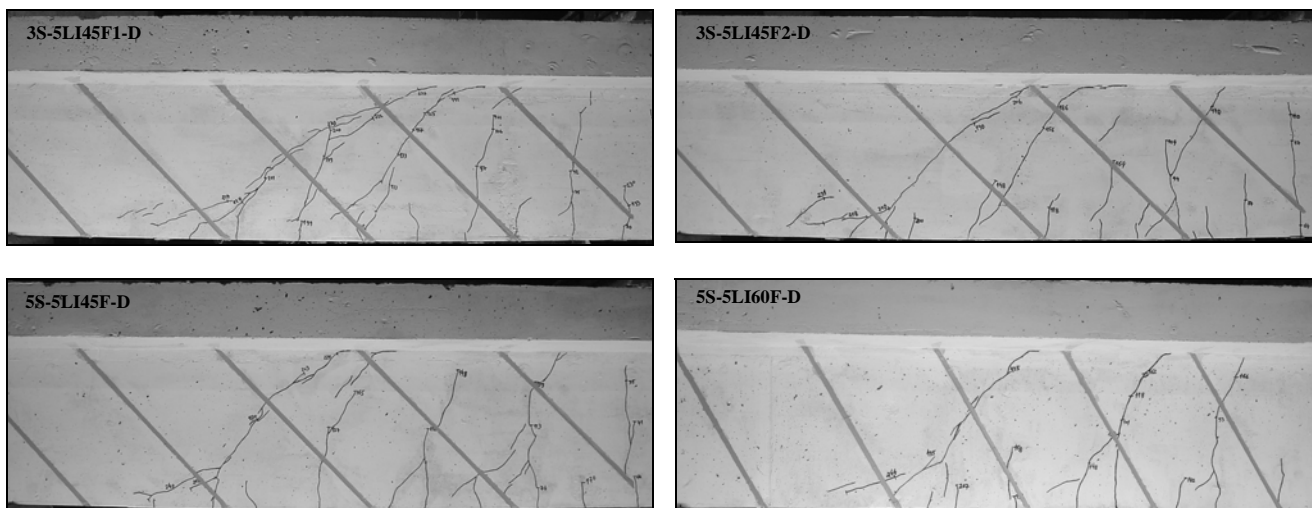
Vigas pré-fendilhadas após a aplicação do reforço de CFRP.
